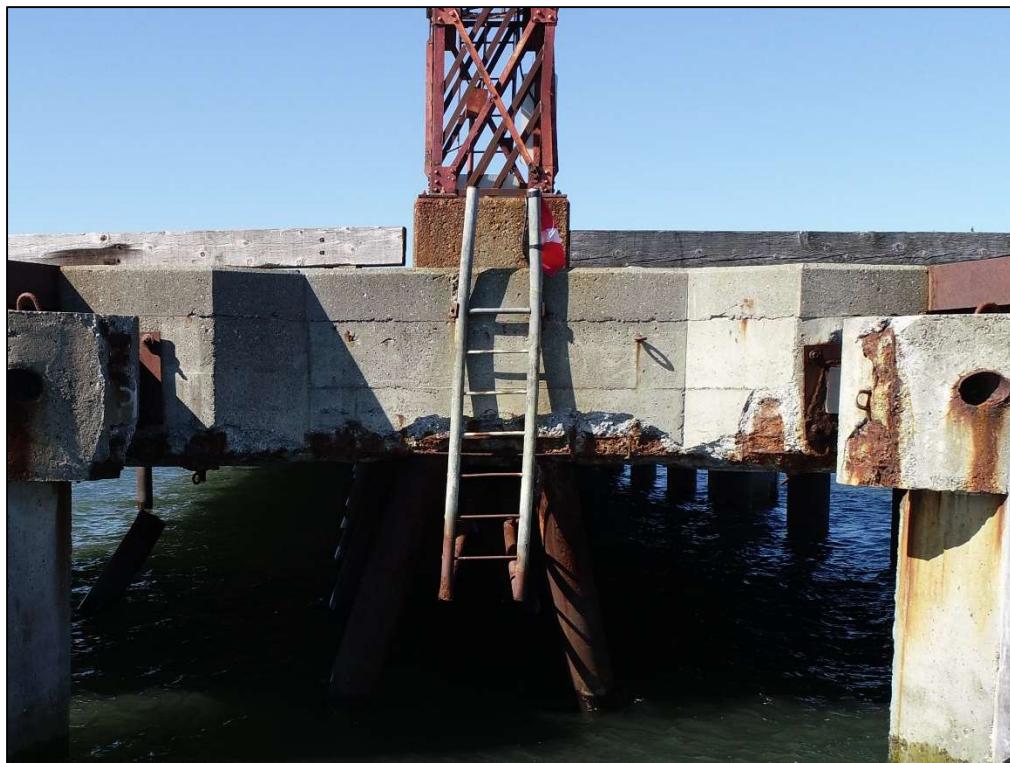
ÉCHELLE – BARREAUX ABSENTS JUSQU'AU NIVEAU DE L'EAU
